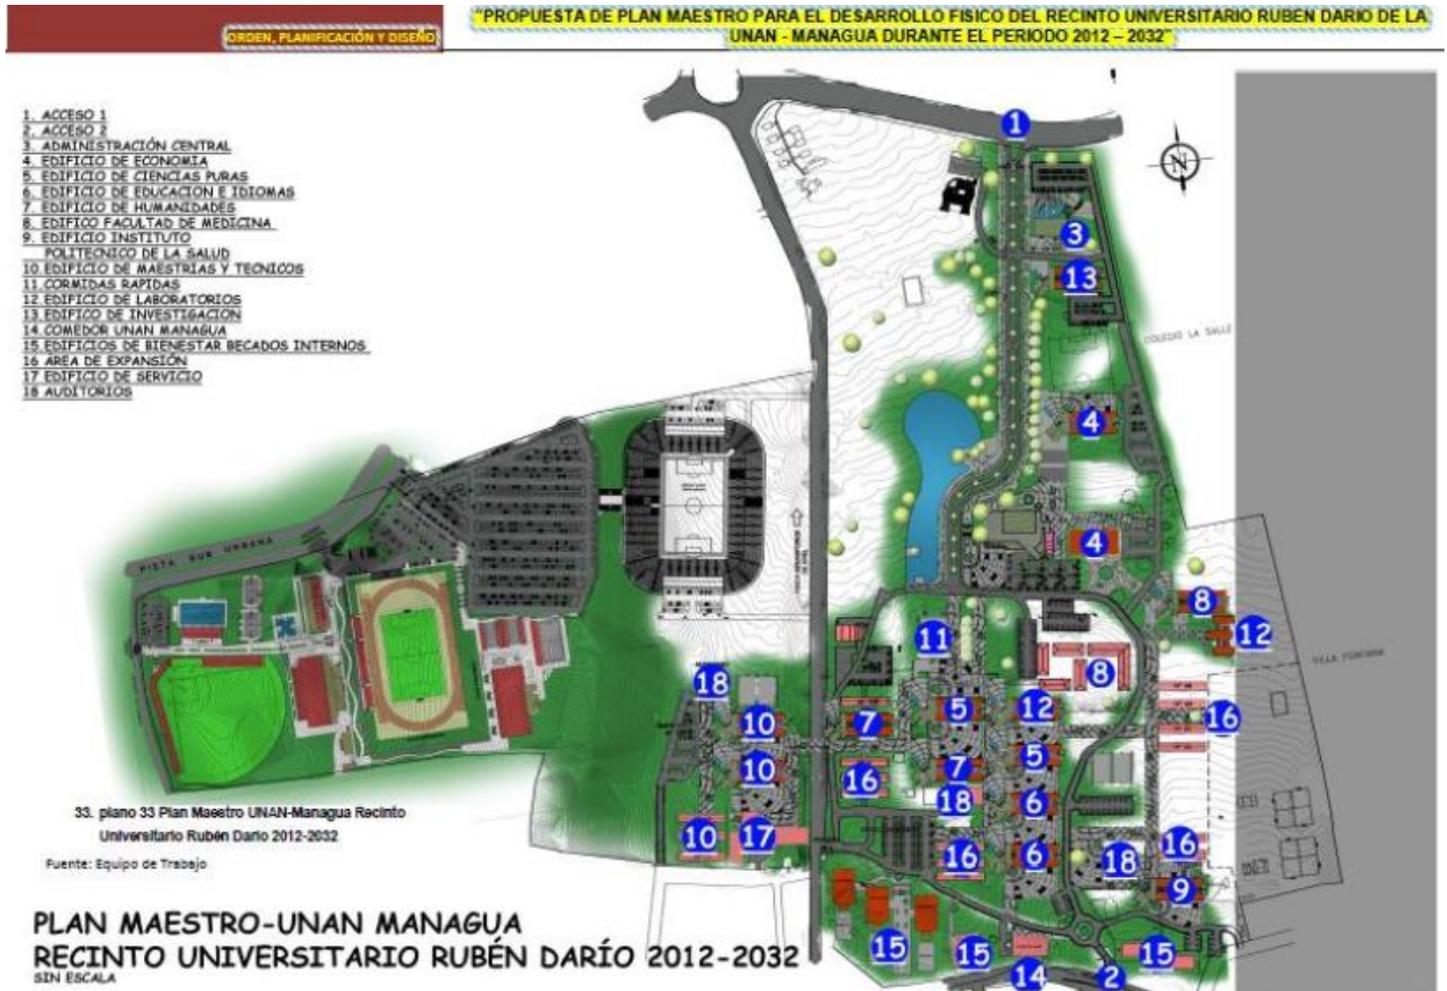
Propuesta de Plan Maestro 2012-2032
